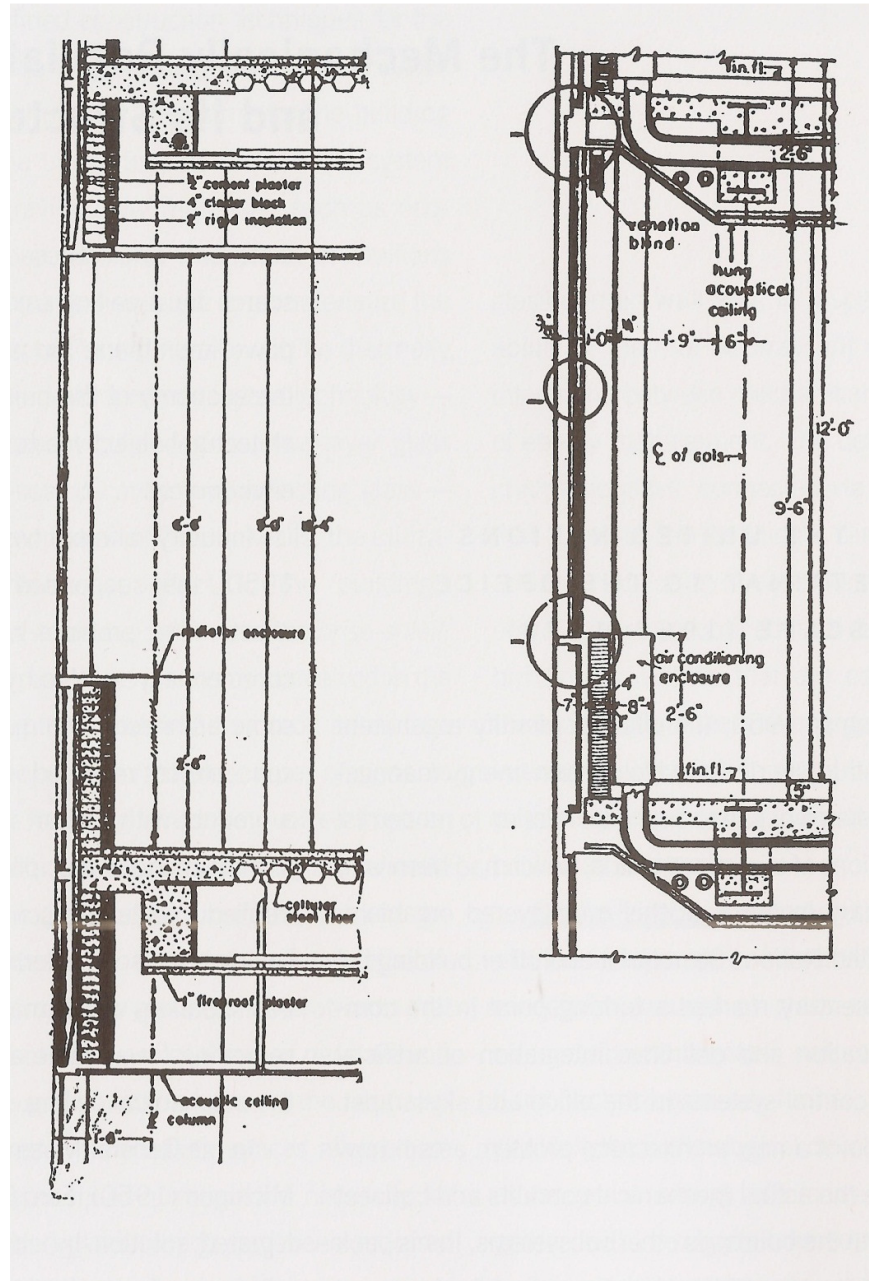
F – Corte tipo das *curtain walls* da Lever House (NY) e do Edifício Sede da ONU (NY)
